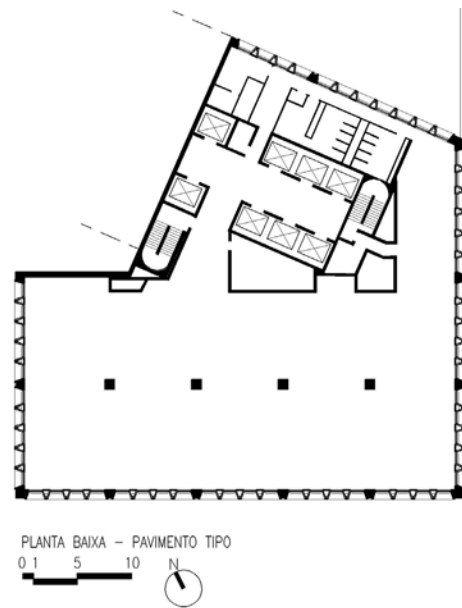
Planta baixa do pavimento térreo – edifício Cleveland Trust.
